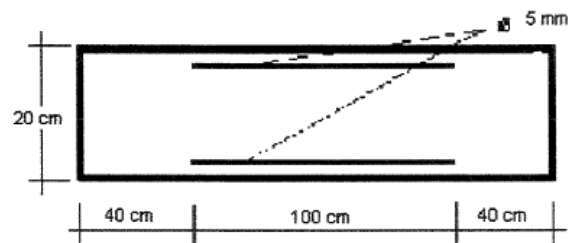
Posicionamento de armadura na viga 4 ensaiada.
